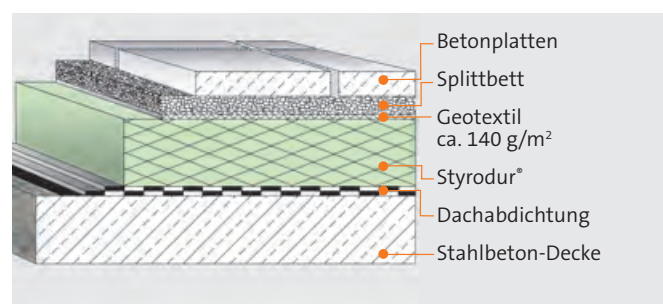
Aufbau eines UK-Terrassendaches mit Betonplatten im Splittbett.
